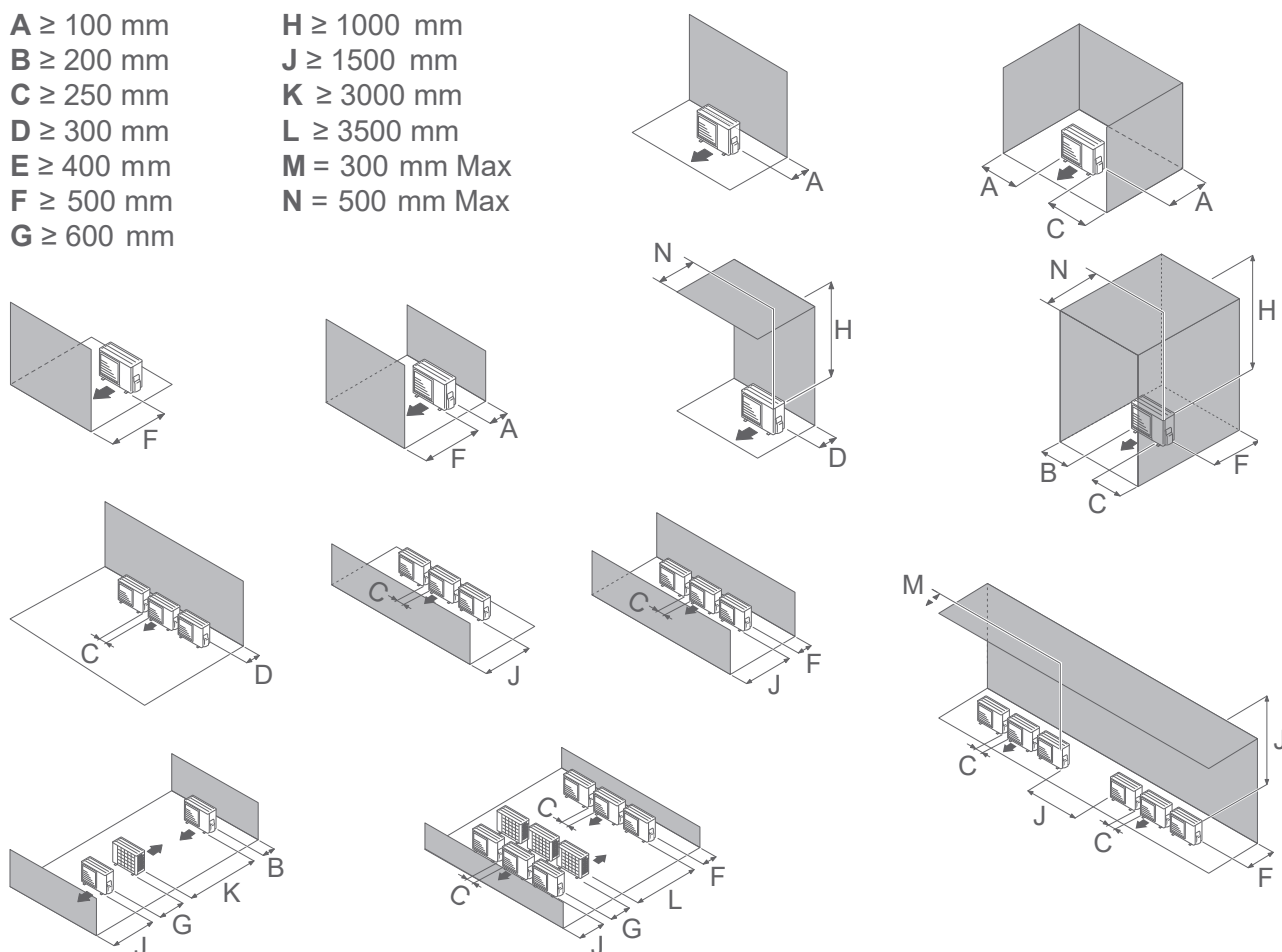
Minimale installatieruimte rond de buitenunit voor gebruik buitenshuis
